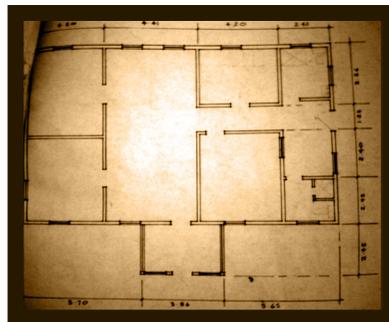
Plano de la Bodega de la Estación Actual de Santa Lucía Cotzumalguapa, 1963
